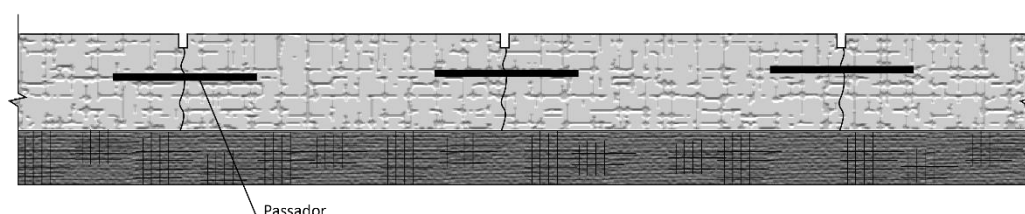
Perfil de pavimento rígido de betão não armado, com juntas e passadores (adaptado de OLIVEIRA, 2000)
